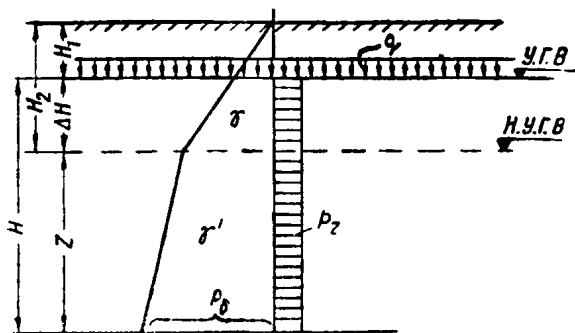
Расчетная схема распределения давлений при подсчете осадки грунта при понижении уровня грунтовых вод
